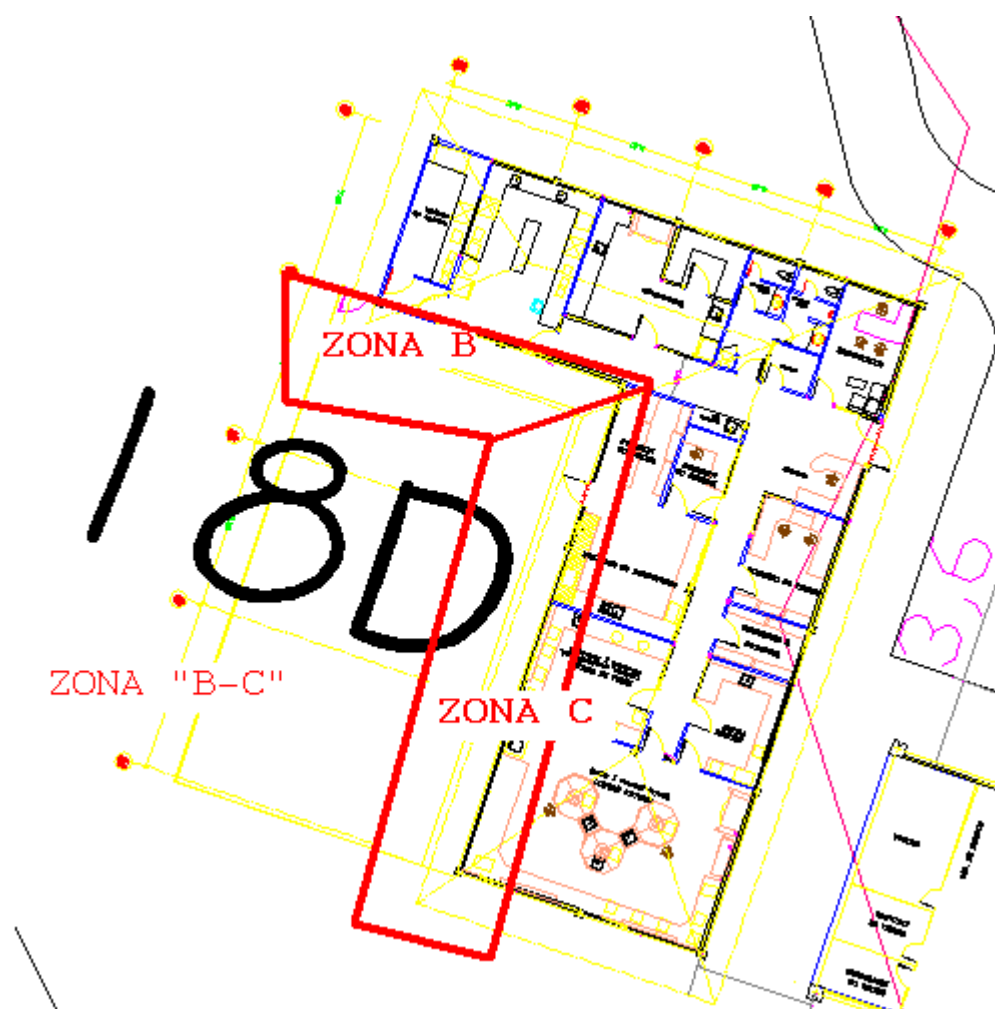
VISTA EN PLANTA DE LA ZONA "B-C"
